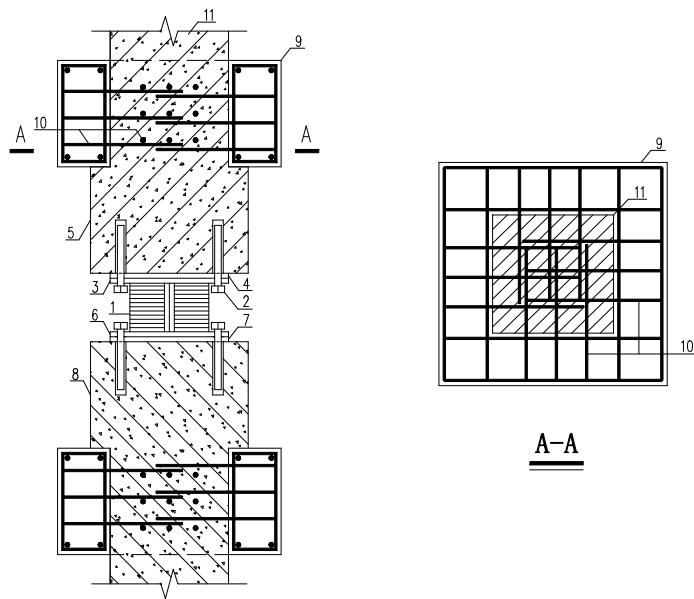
钢筋混凝土框架柱托换及隔震支座安装示意图
